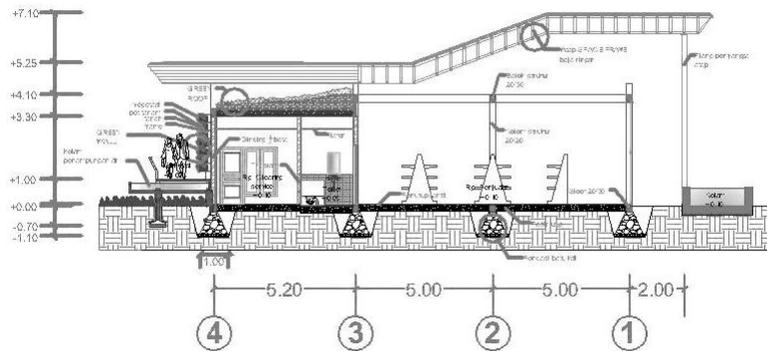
Potongan Bangunan Skematik Area Terapi
